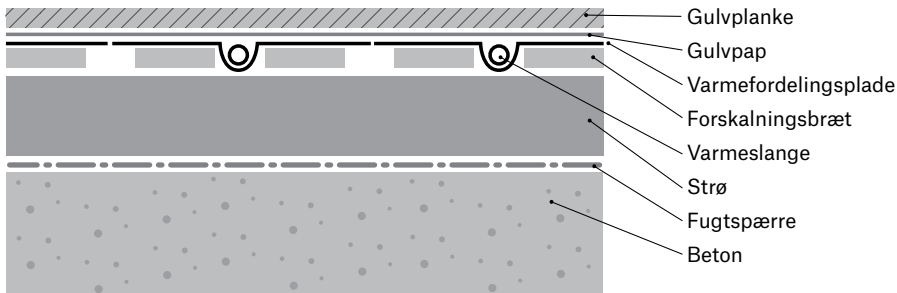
Tværsnit gulvspånplade på beton med varmeslanger
